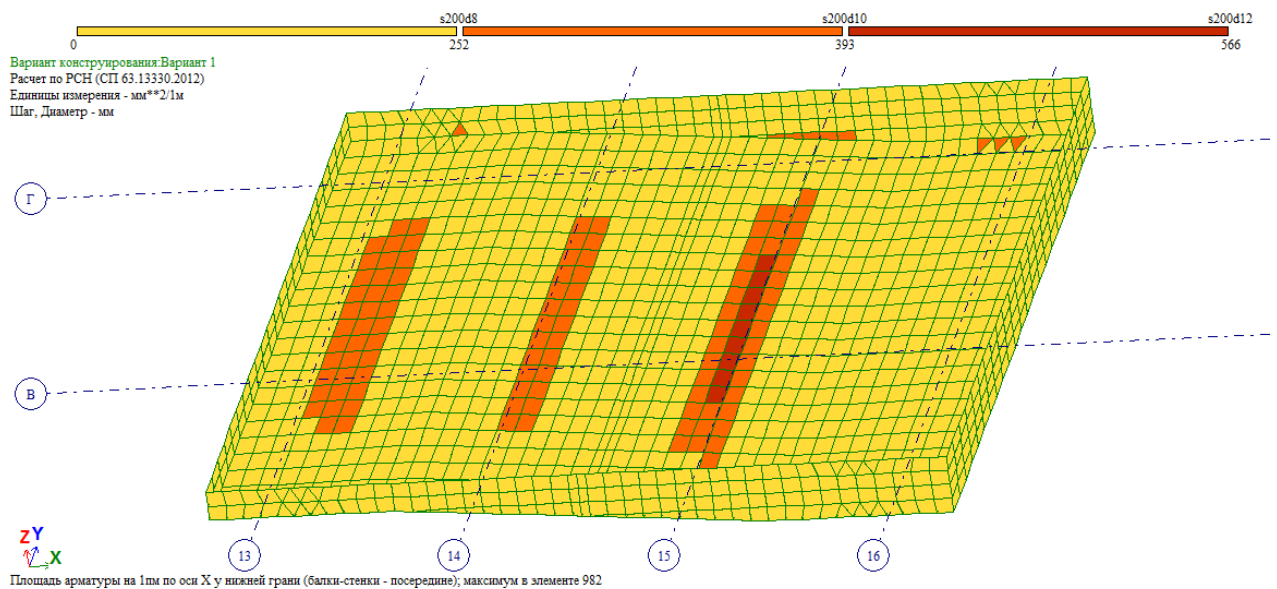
Продольная арматура нижней зоны вдоль буквенных осей
